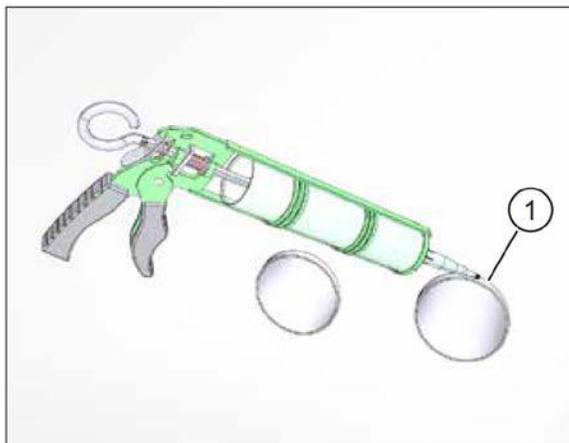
герметизировать вентиляционные трубы на наружной стене
